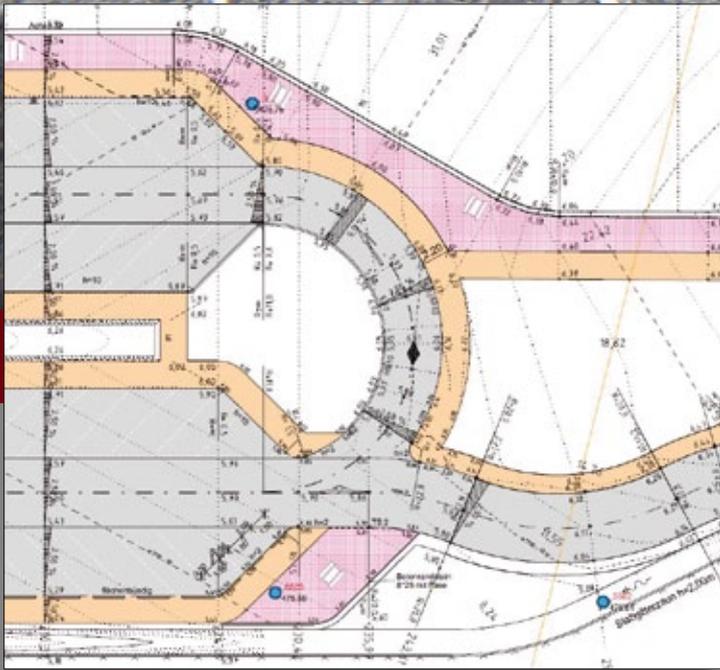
Ausschnitt aus dem Deckenhöhenplan.
